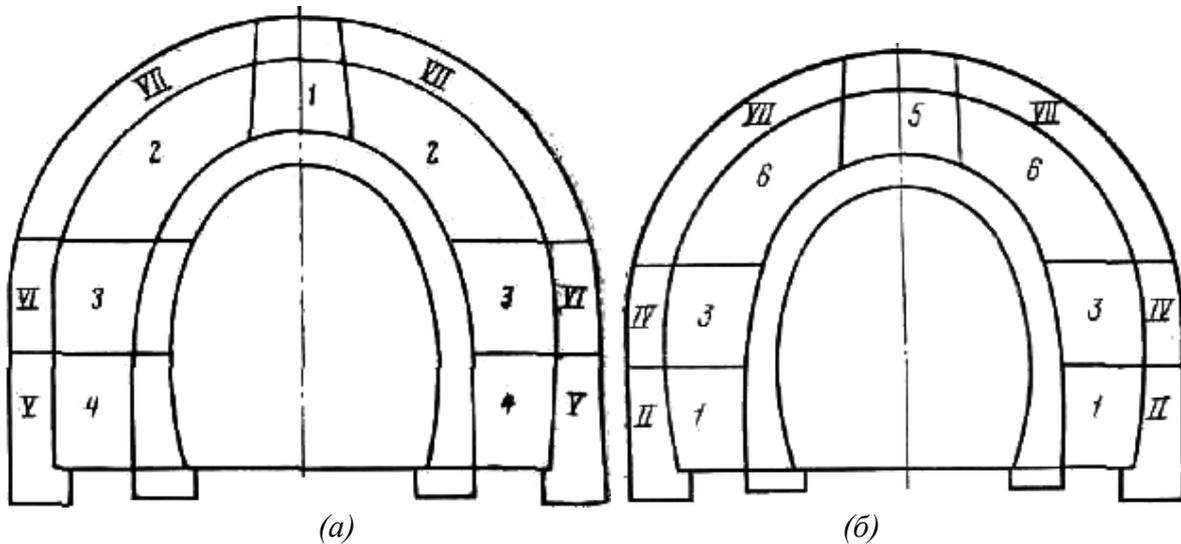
Схема последовательности выполнения работ по доработке профиля однопутного тоннеля под двухпутное движение. (а) – сверху вниз: 1 – проходка верхней штольни; 2 – разработка калотты; 3, 4 – разработка боковых штолсс; 5, 6 – бетонирование стен; 7 – бетонирование свода; (б) – снизу вверх: 1 – проходка штолен первого яруса; 2 – бетонирование стен на участке штолен первого яруса; 3 – проходка штолен второго яруса; 4 – бетонирование стен на участке штолен второго яруса; 5 – проходка верхней штольни; 6 – разработка калотты; 7 – бетонирование свода
